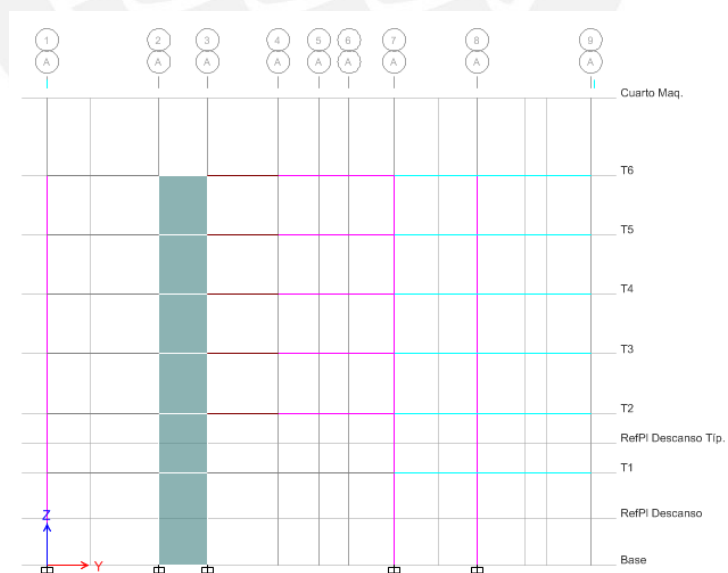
VISTA EN CORTE DEL MODELO ESTRUCTURAL.
